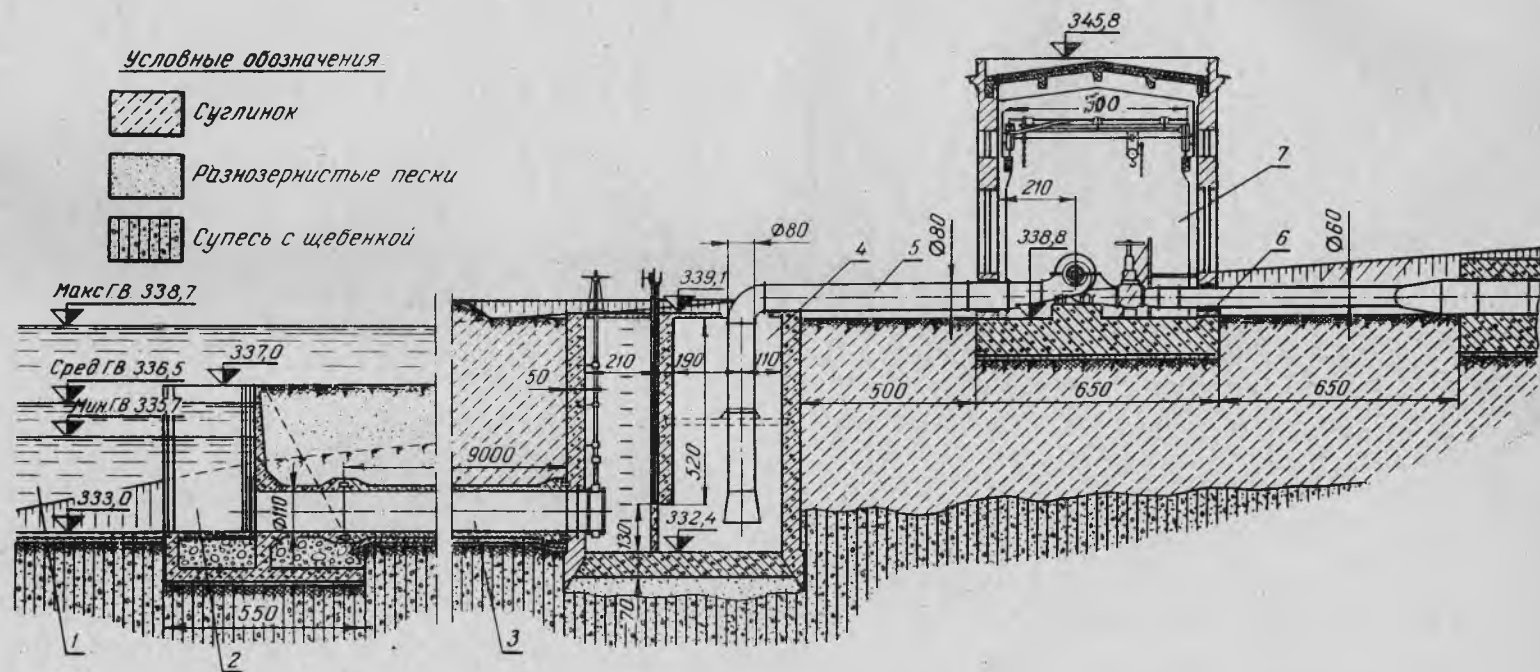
Здание насосной станции с отметкой пола на уровне стояния максимального горизонта грунтовых вод:
